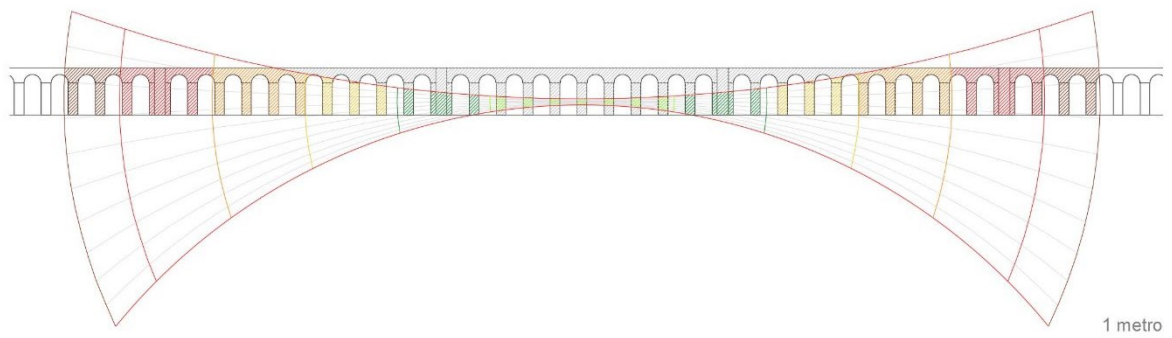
Estudio de la zona de coberturas en planta y alzado a 12 m de distancia del acueducto
